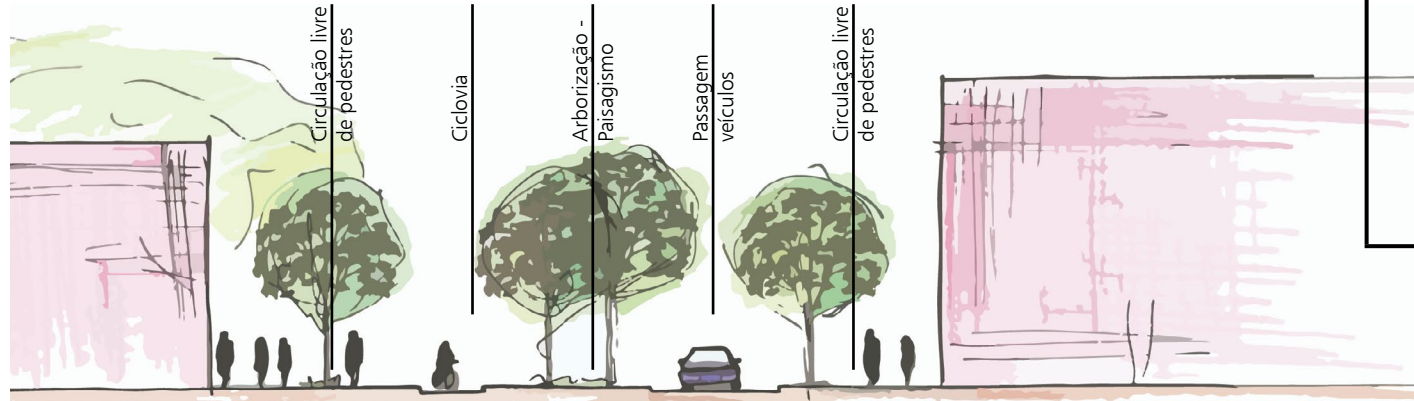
Croqui esquemático de intervenção de projeto no calçadão
